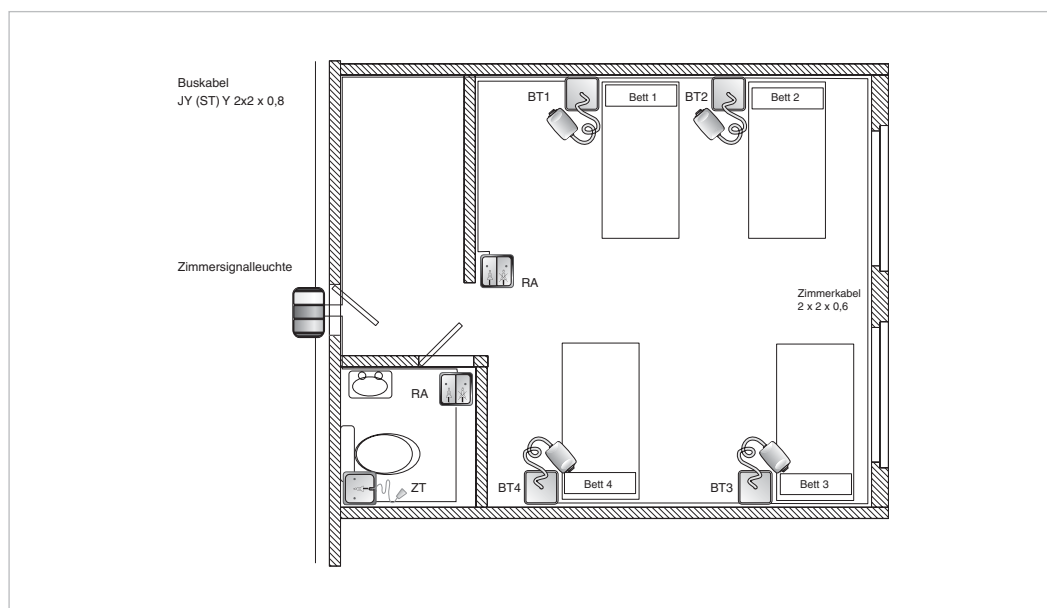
, Planungsbeispiel Zimmer mit Bad/WC
